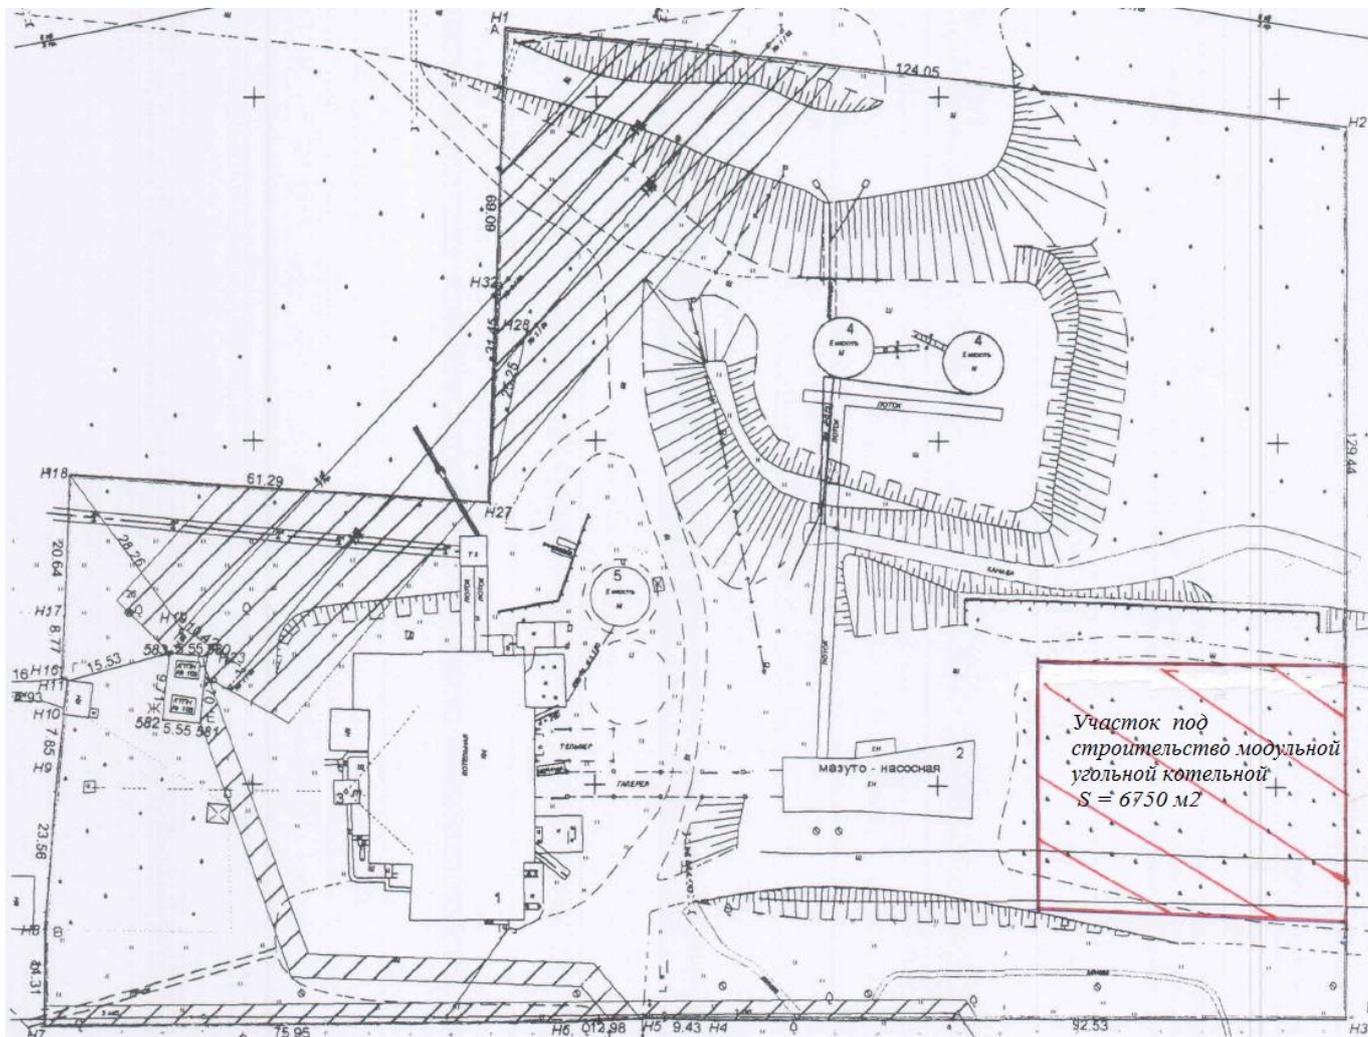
Схема расположения ЗУ под строительство котельной на кадастровом плане пос. Краснореченский
